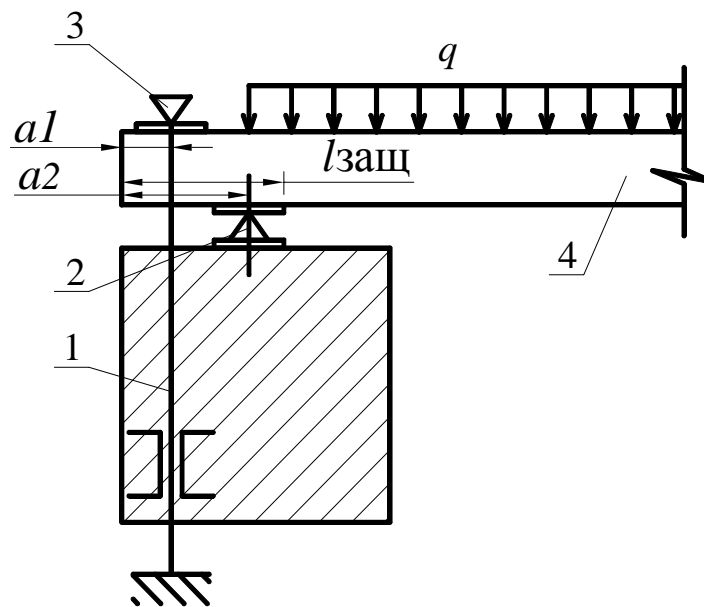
Схема испытания консоли: 1 – анкерная тяга; 2 – нижняя опора; 3 – верхняя опора; 4 – испытываемая конструкция
